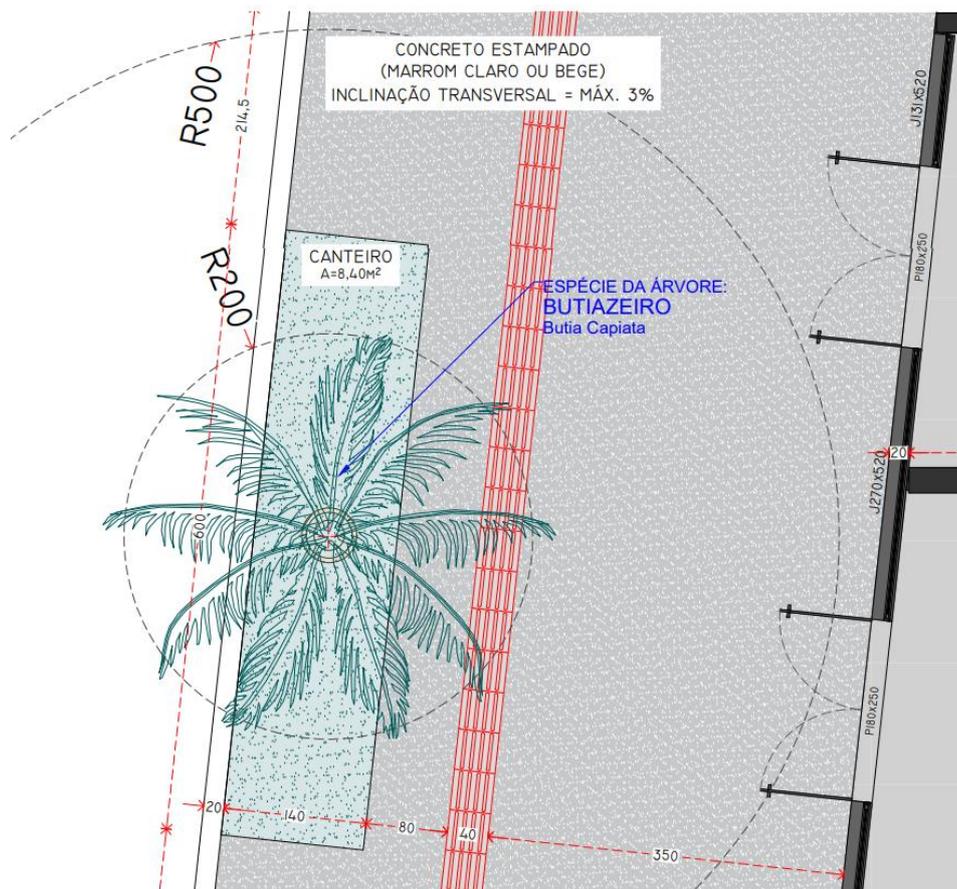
Detalhe para canteiro, calçada e fachada das lojas junto a Av. Brasil
